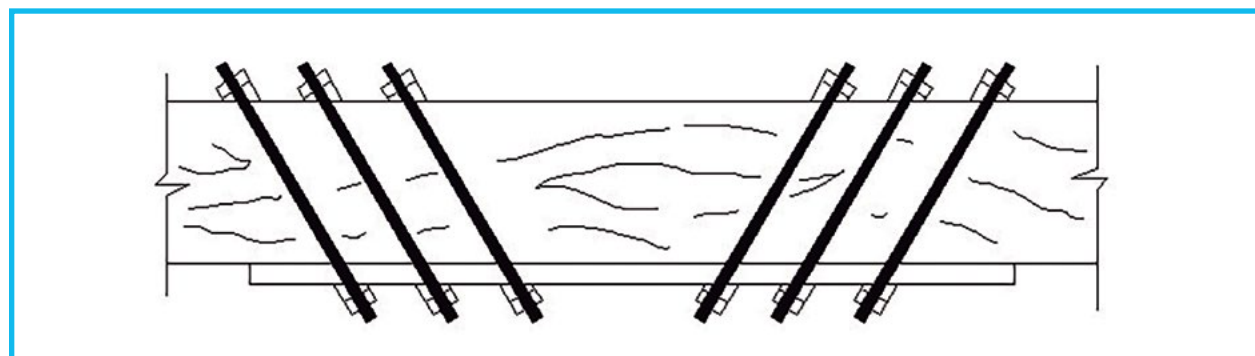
Viga agrietada longitudinalmente reforzada con planchas atornilladas
